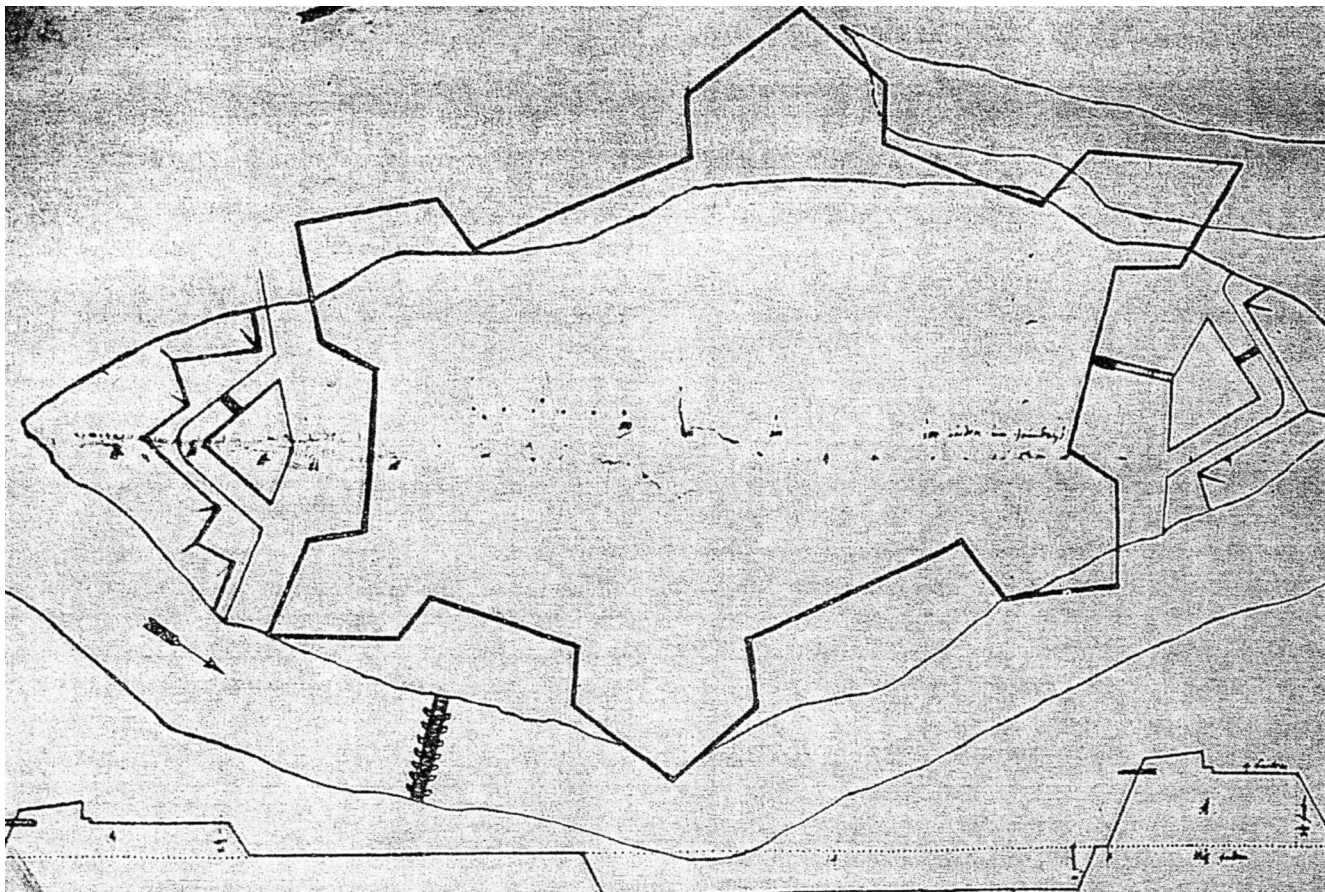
Domenico Trezzini e Pietro I, *Pianta per la ricostruzione in muratura della Fortezza dei Santi Pietro e Paolo*, 1706, disegno (Navone 1999)
